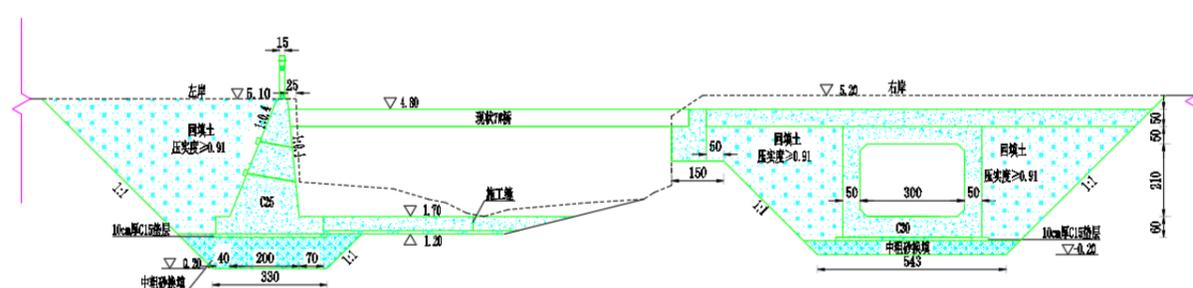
7#桥剖面图(上游侧) 典型断面图
